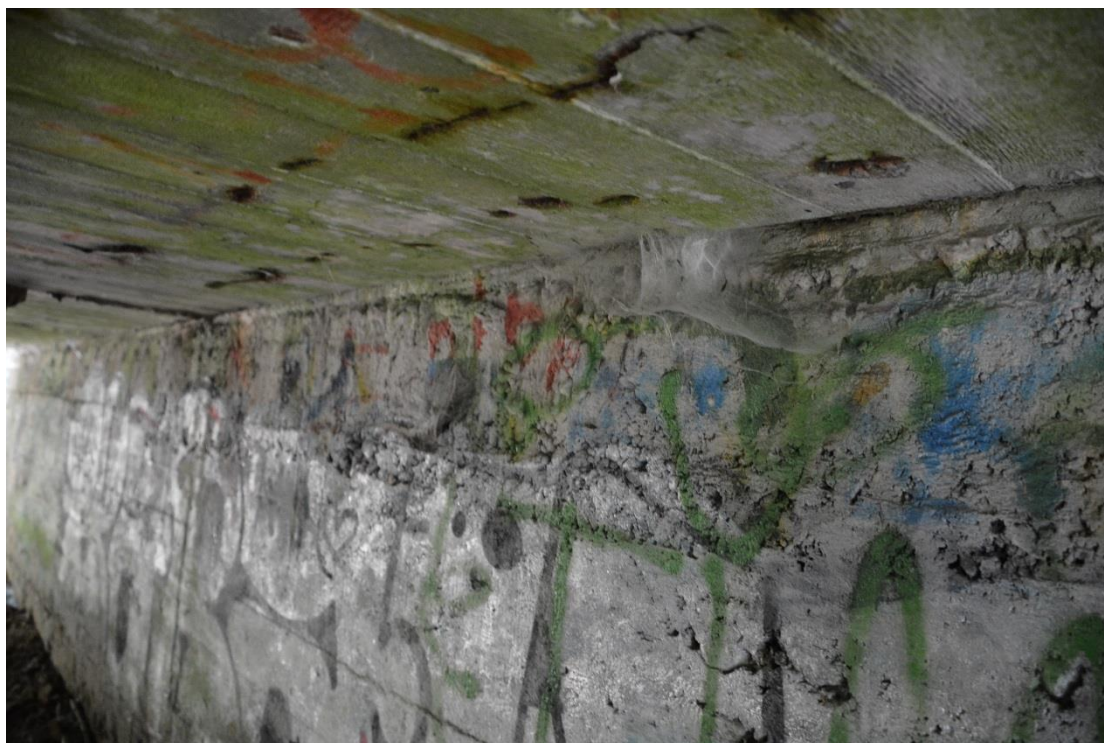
Widok nadbudowy gzymsu przęsła w miejscu ubytku brak widocznego zbrojenia, nieregularne, poziome rysy na skrzydełku, korozja betonu, ubytki betonu
